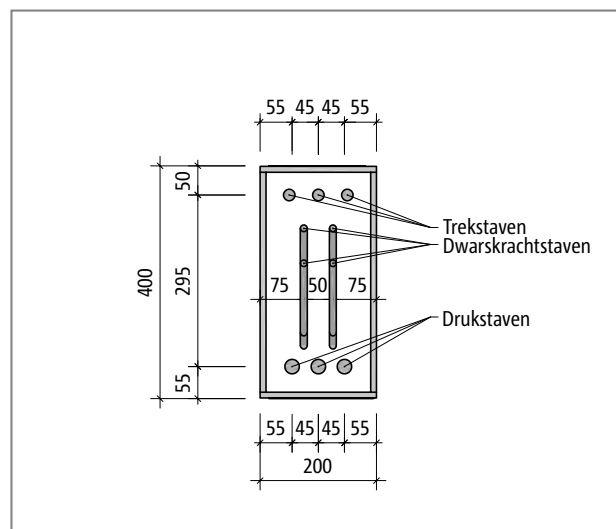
Schöck Isokorb® T type B-M3-V2: Bovenaanzicht
